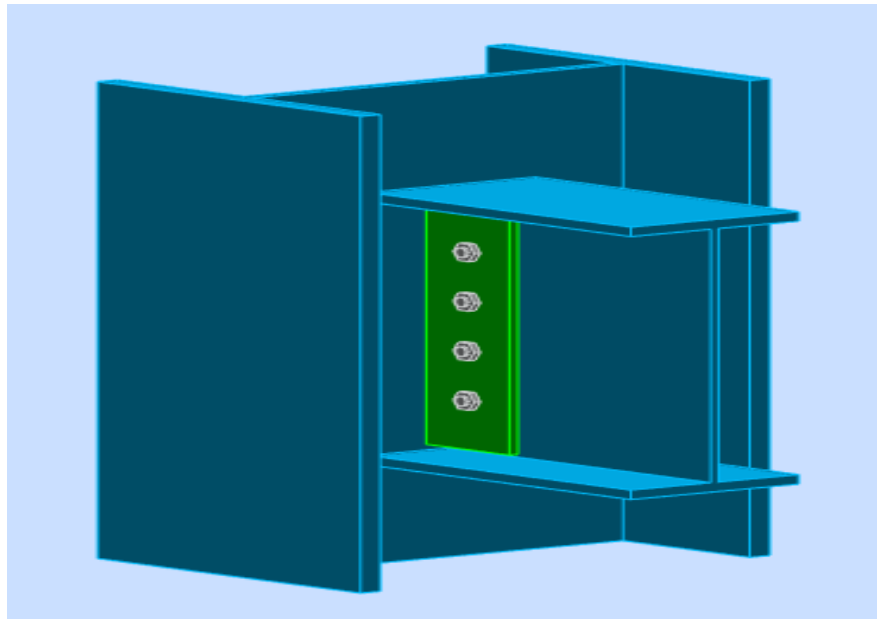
Assemblage Poteau-Poteau (HEA400-HEA400).
